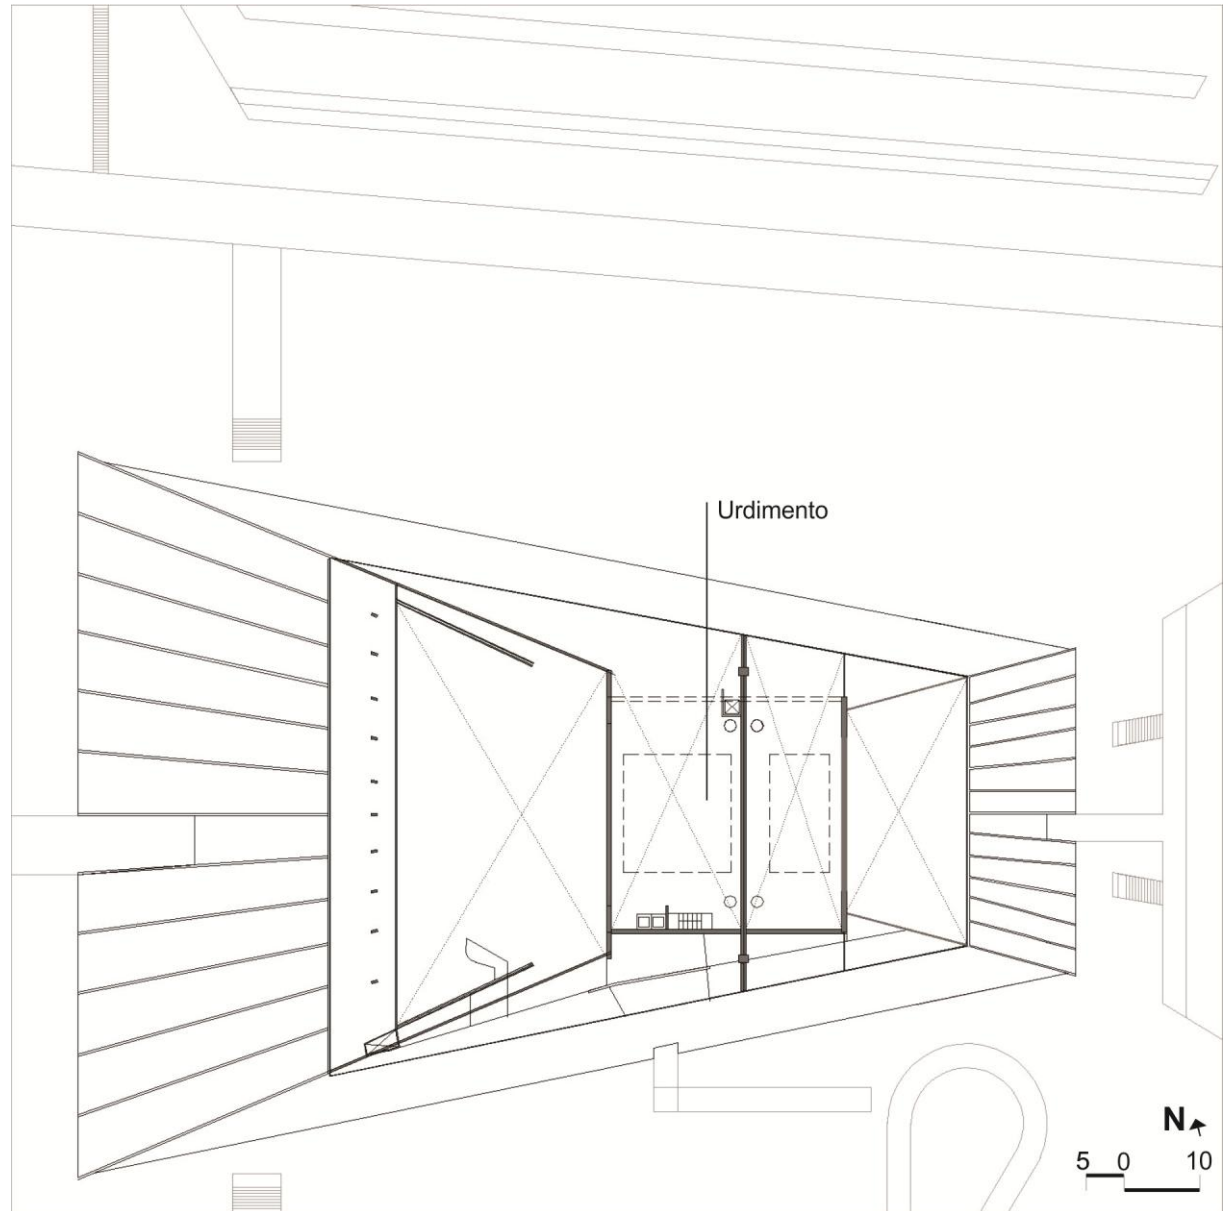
Planta Baixa - 2º Pavimento (+7,75 m).
